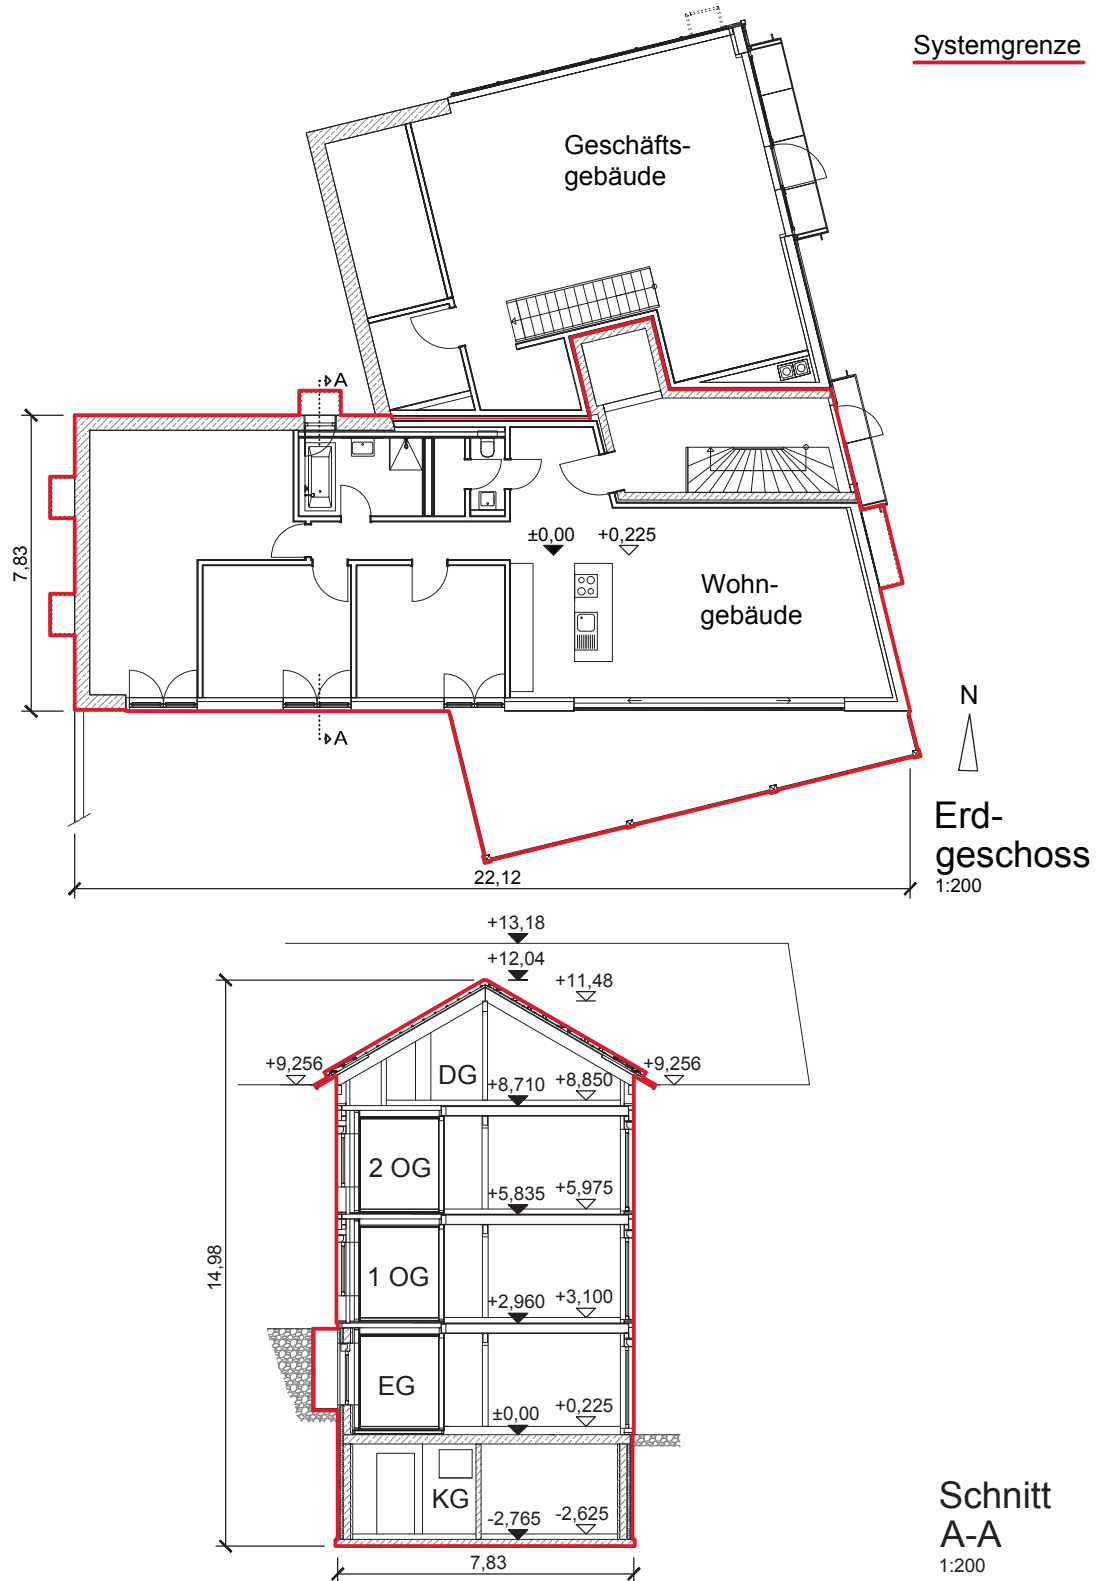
Grundriss Erdgeschoss (oben) und Schnitt (unten) des Mehrfamilienhauses
